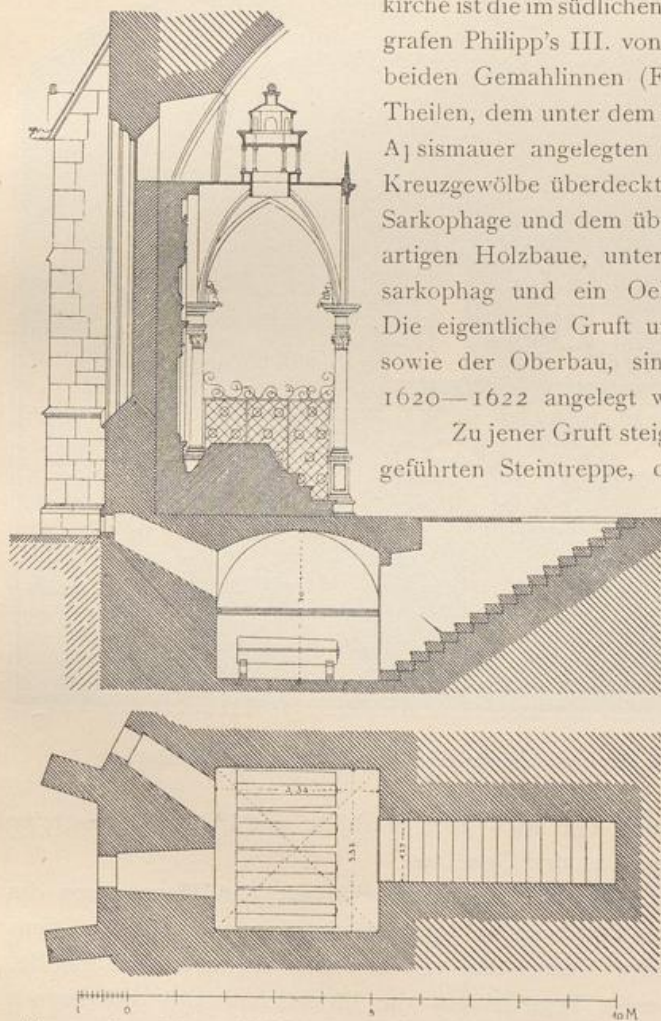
Grundriss und Schnitt der Gruft Philipp's III. in Butzbach.
